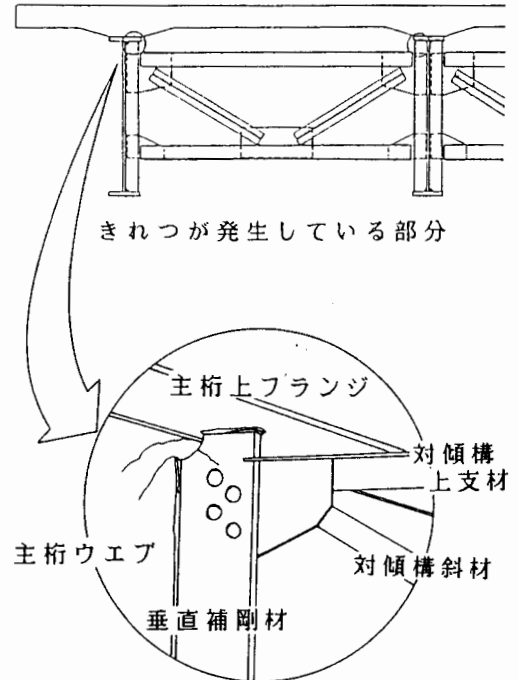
垂直補剛材と上フランジとの溶接部近傍に生ずるきれつの様式
